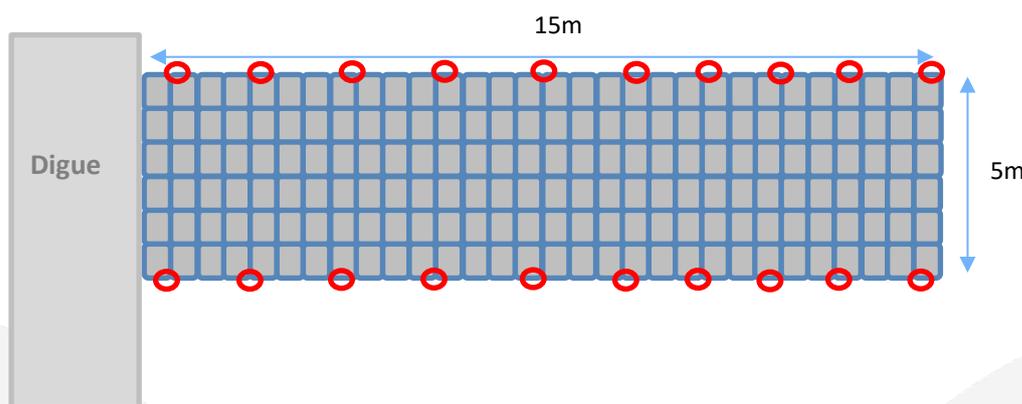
schématisation de l'appontement flottant en cubisystems (source : SUEZ CONSULTING)
